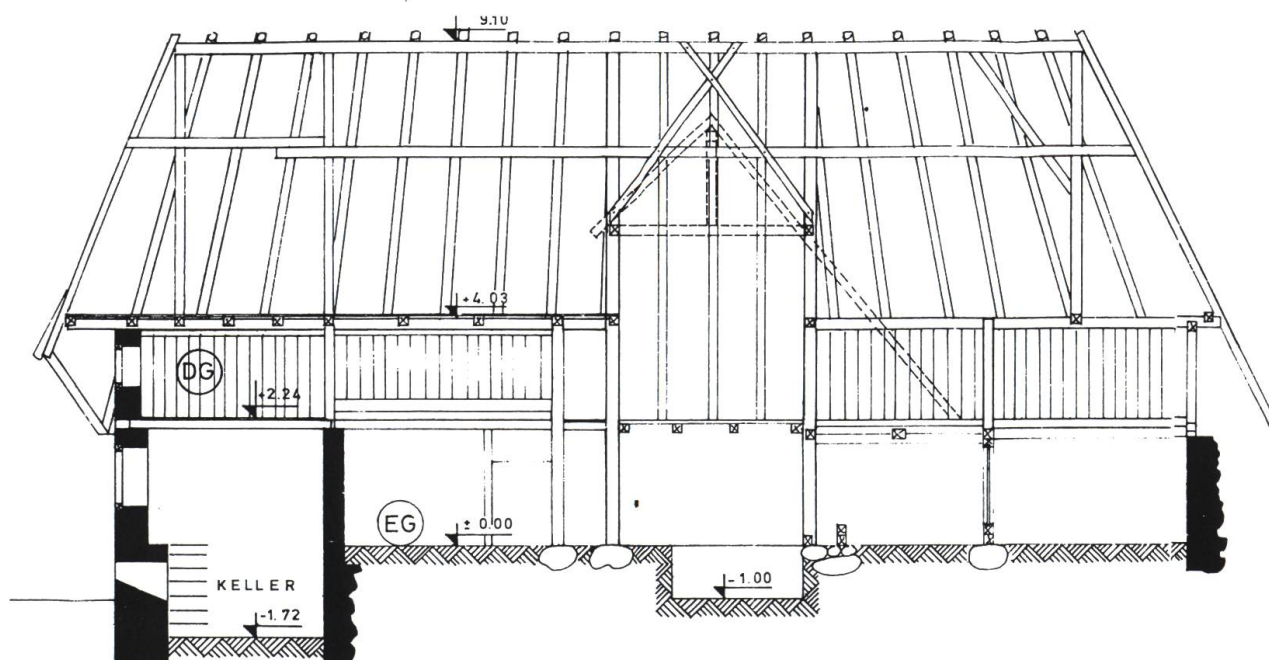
Grossherrischwand DE, Klausenhof. Grundrisse Erdgeschoss Obergeschoss (Längsschnitt) zeigen den inneren Aufbau eines strohgedeckten Firstständerbaus. Der Wohnteil wurde nachträglich um Raumtiefe vergrößert.
